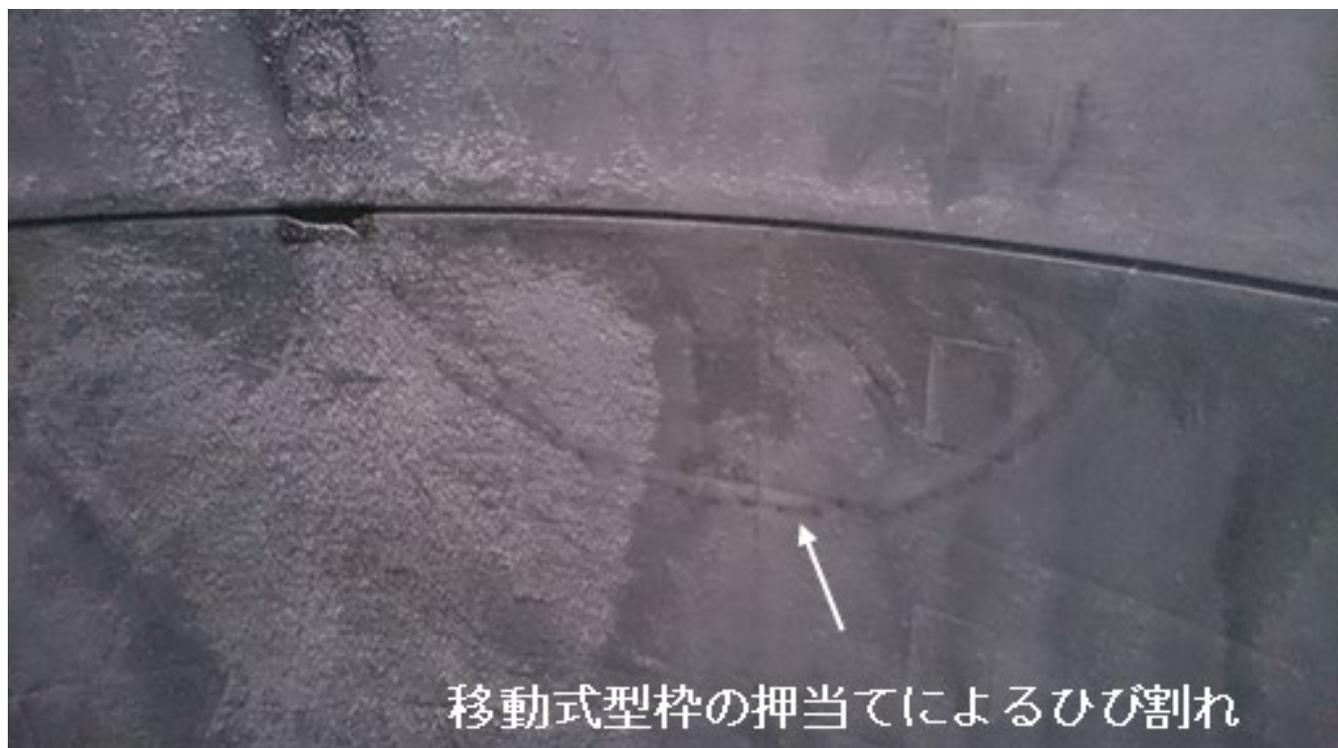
移動式型枠の押し当てによるひび割れ
